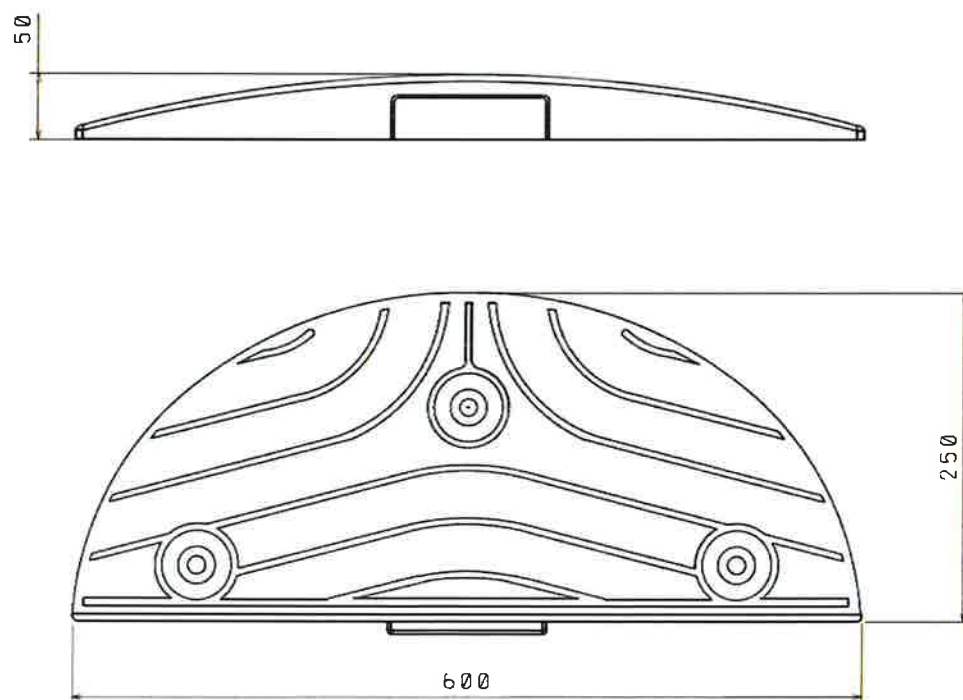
Element końcowy prawy/lewy progu podrzutowego PpVBz-3/60
